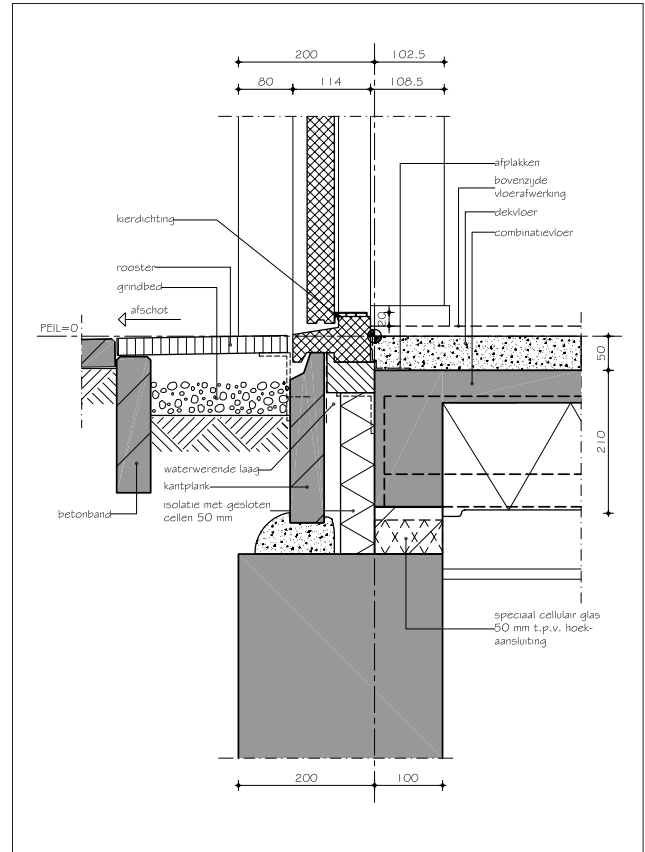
Aansluiting vloer/wand bij houten gevelbekleding.
